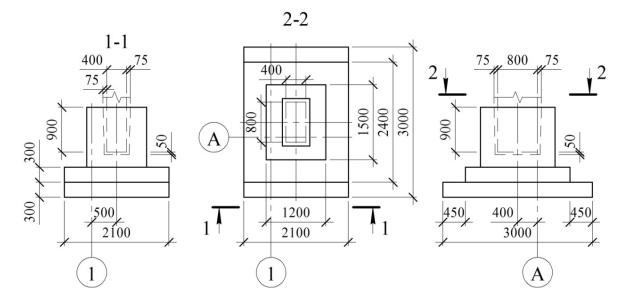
Конструктивная схема фундаментов, расположенных по крайней оси
